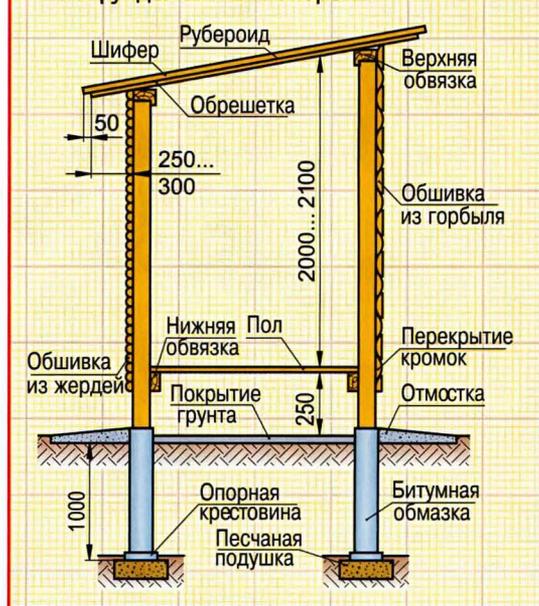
Поперечный разрез хозблока по фундаментным опорам.
